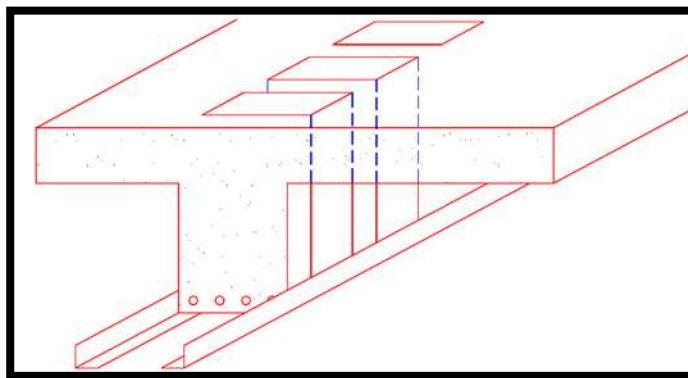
Refuerzo de viga con ángulos en la parte inferior.
